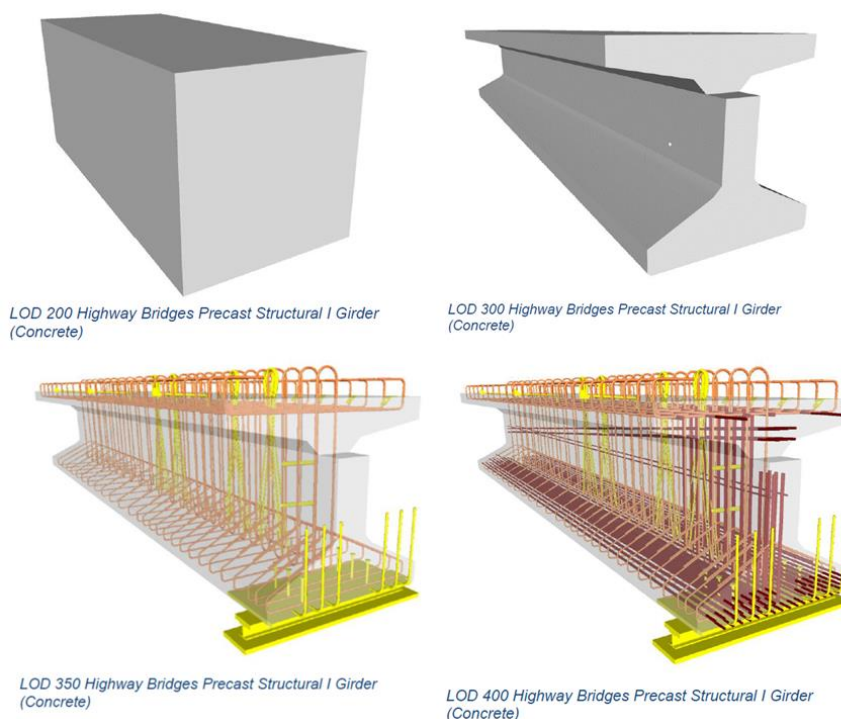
Exemplo Highway Bridges Precast Structural I Girder LOD 200, 300, 350 e 400 (BIMForum, 2019)
